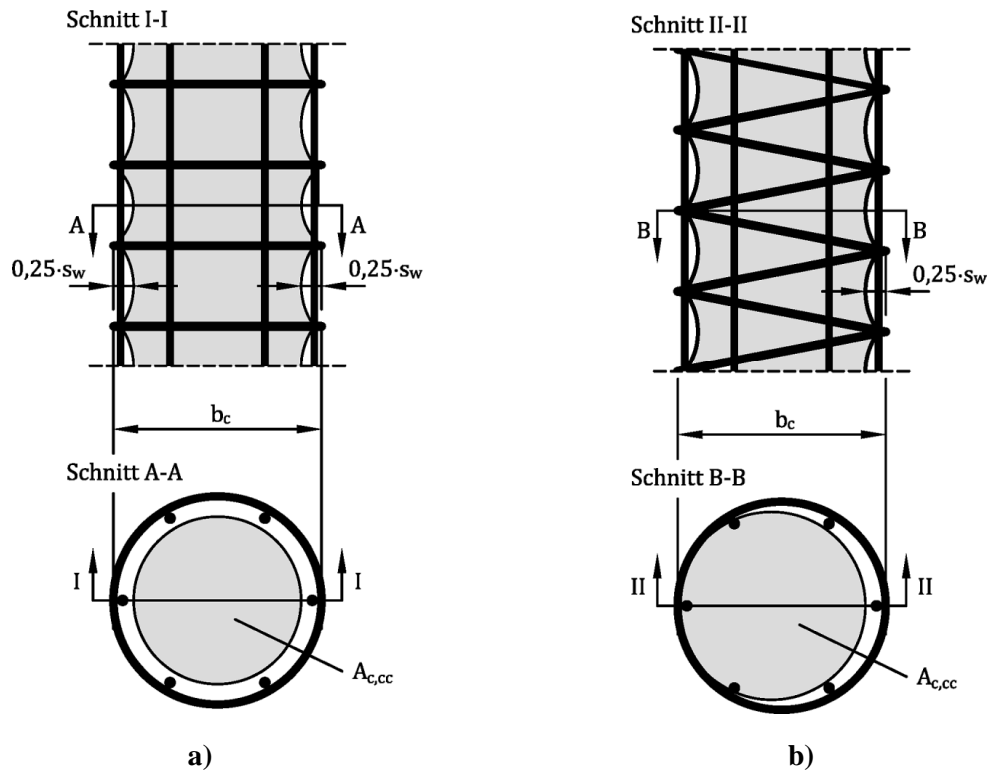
Umschnürte Betonquerschnittsfläche von Stahlbetondruckgliedern mit Kreisquerschnitt gemäß dem Ansatz nach MODEL CODE 2010 [CEB-10] bei Anordnung
